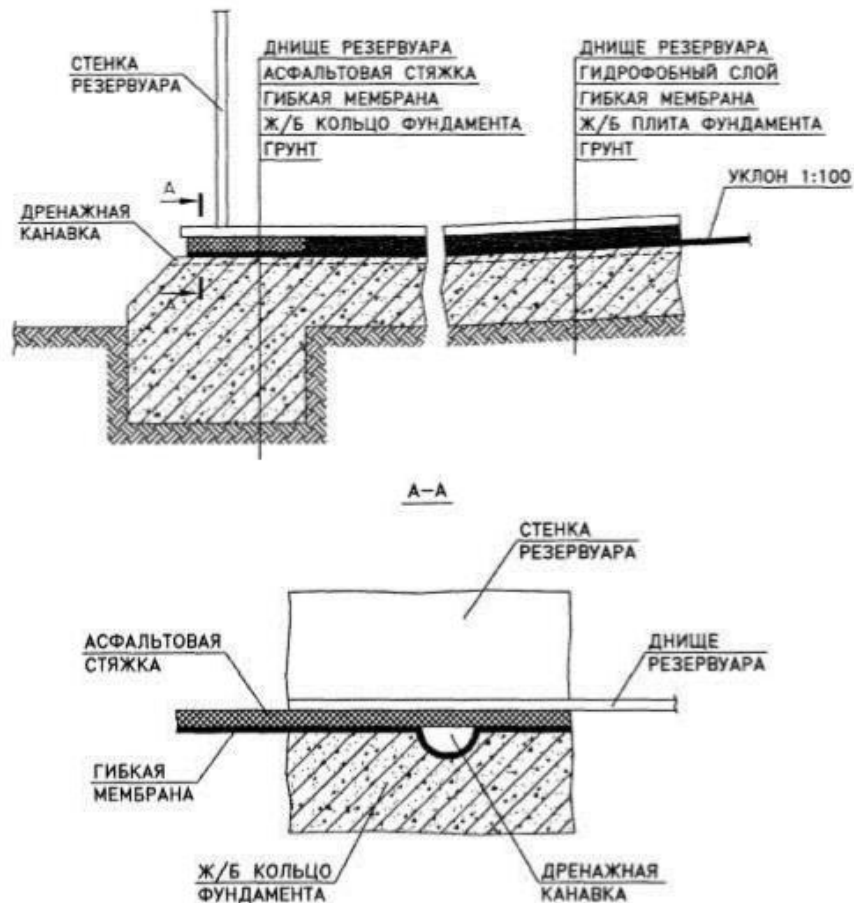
Фундамент в виде сплошной железобетонной плиты [12]
